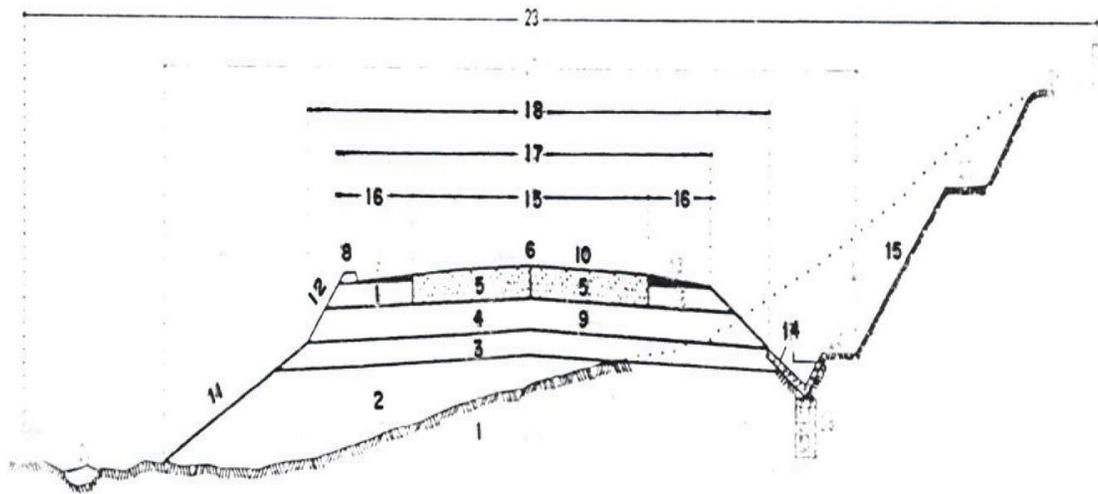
sección transversal de un pavimento de concreto hidráulico.
